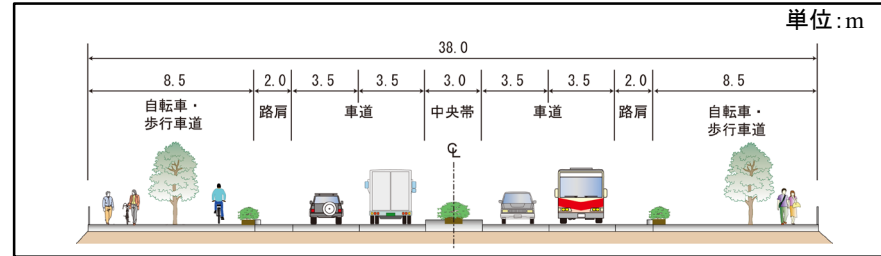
事業中区間の標準横断面図 (A-A' 断面)
